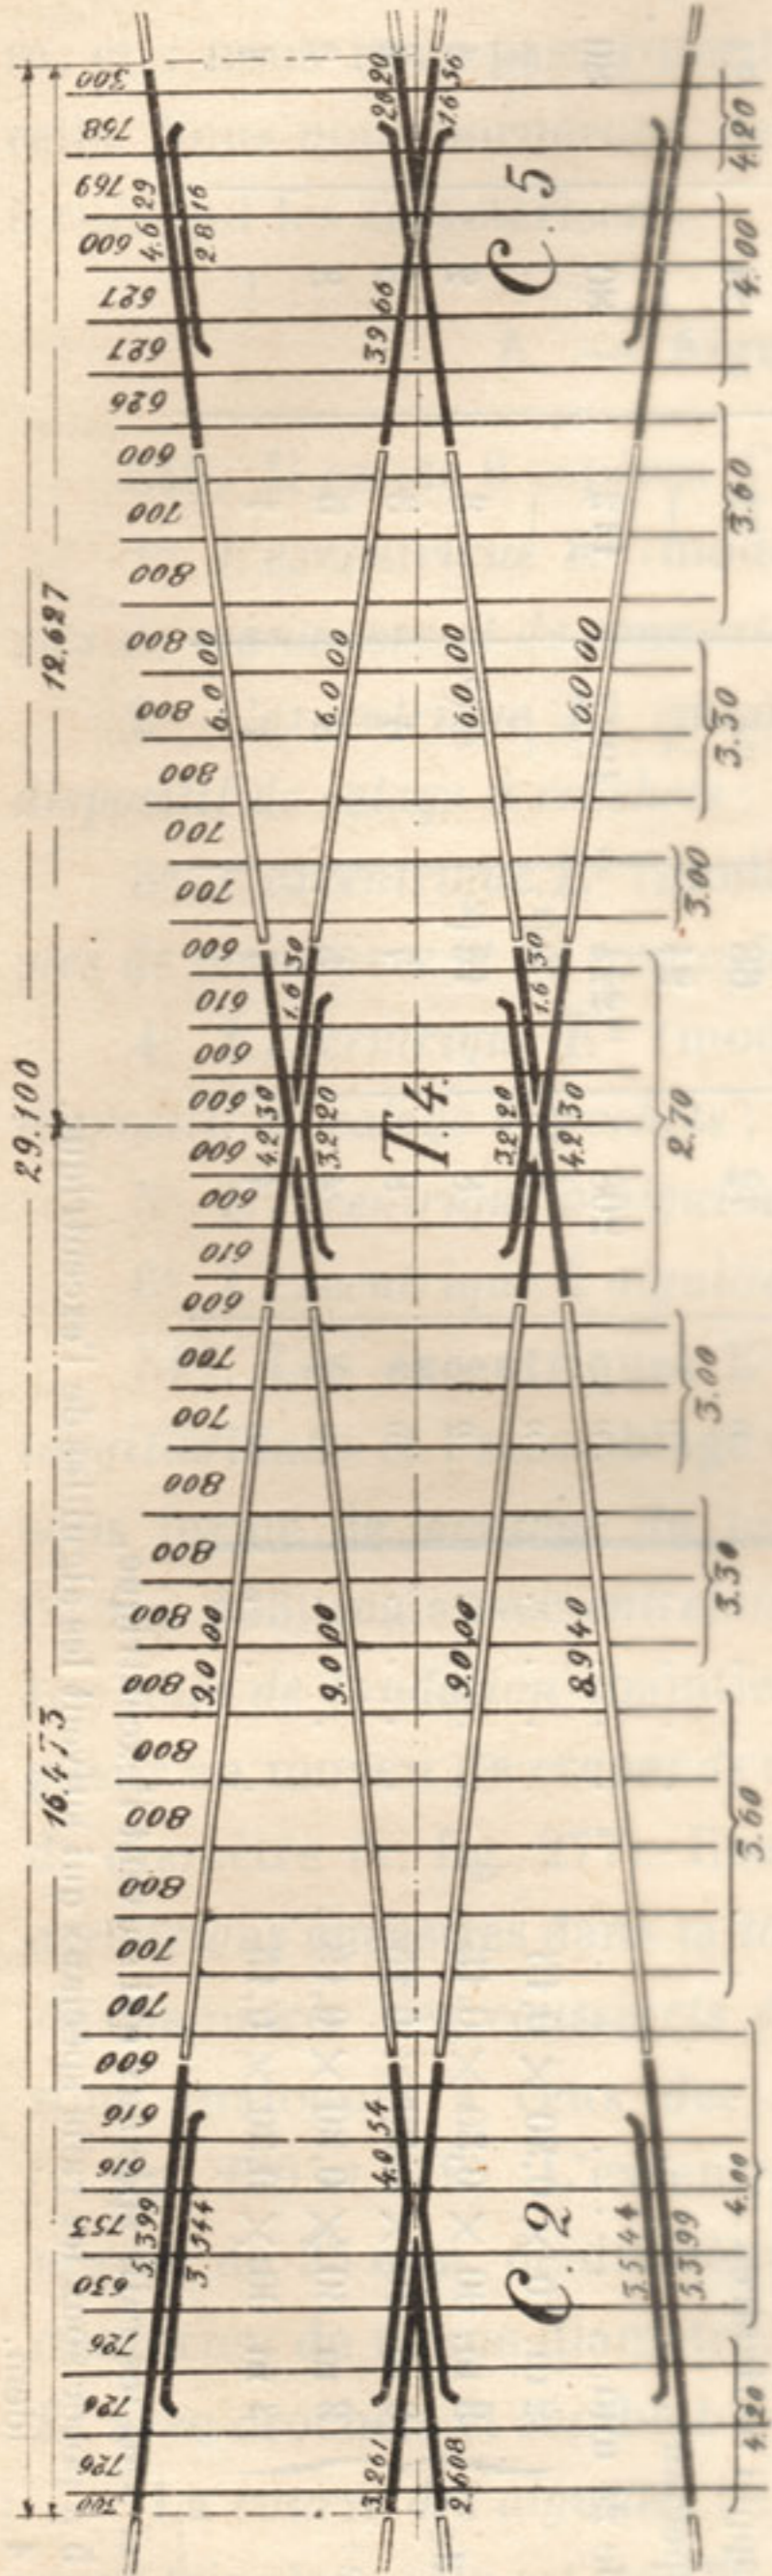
Traversée d'une voie par T₄ entre croisements C₂ et C₅ en rails de 52 kg. par m. ct.
